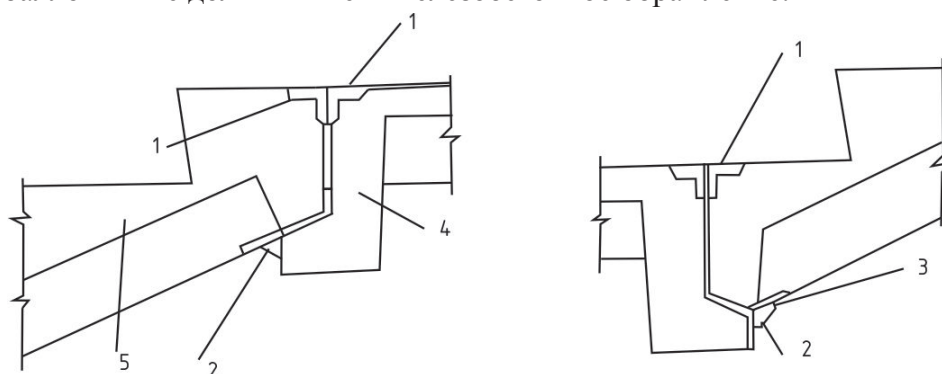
Крепление железобетонной лестничных маршей ребристой конструкции к площадкам
